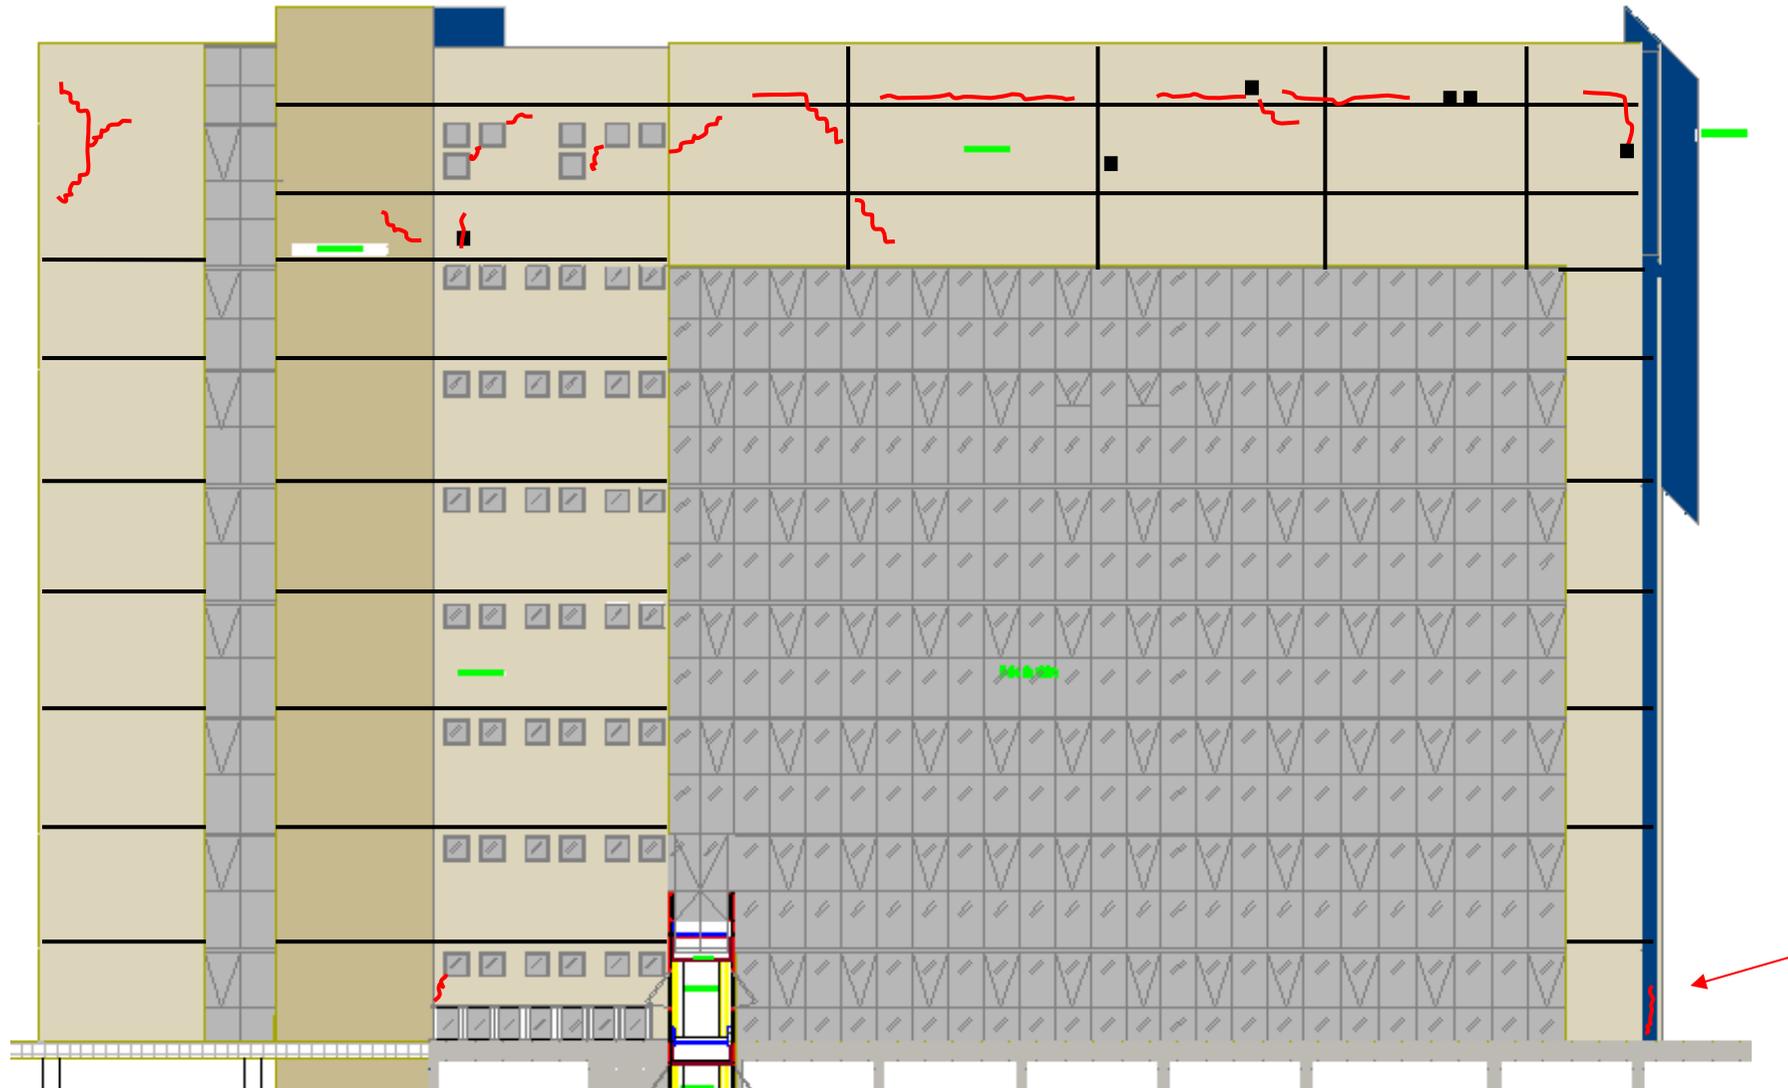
Fachada norte. Croqui esquemático (sem escala), meramente ilustrativo com mapeamento das fissuras e descolamentos.
